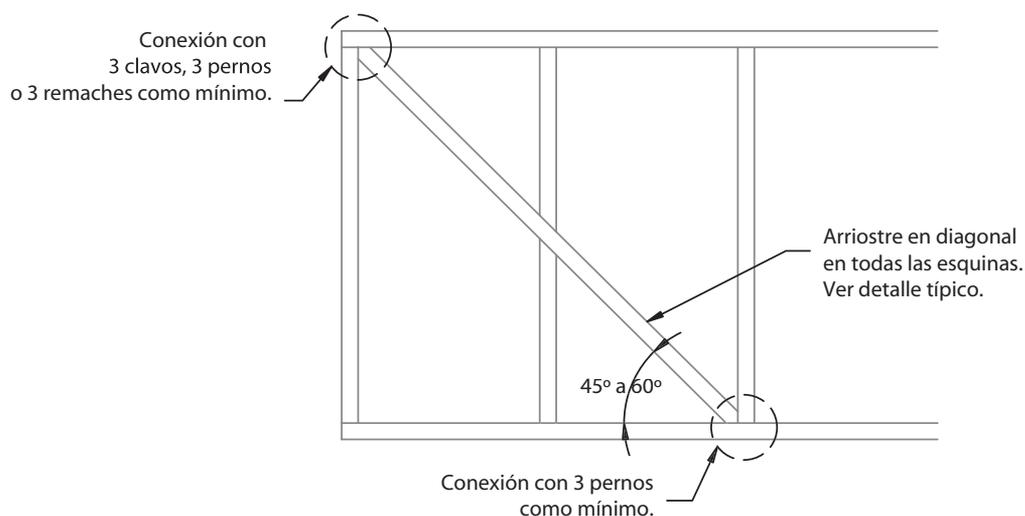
Arriostramiento de paredes delgadas a doble forro.
